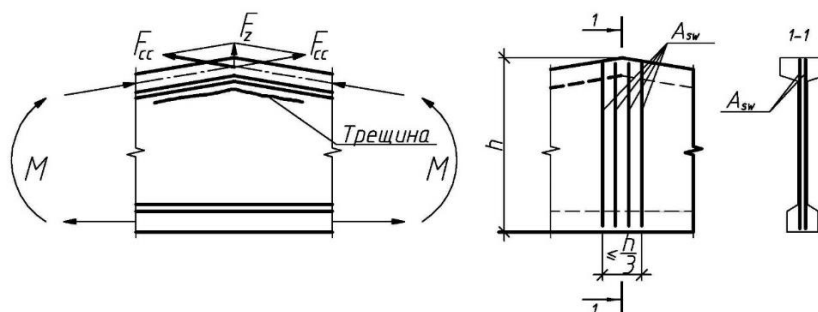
Схема образования трещин отрыва и армирование конька двускатной балки
